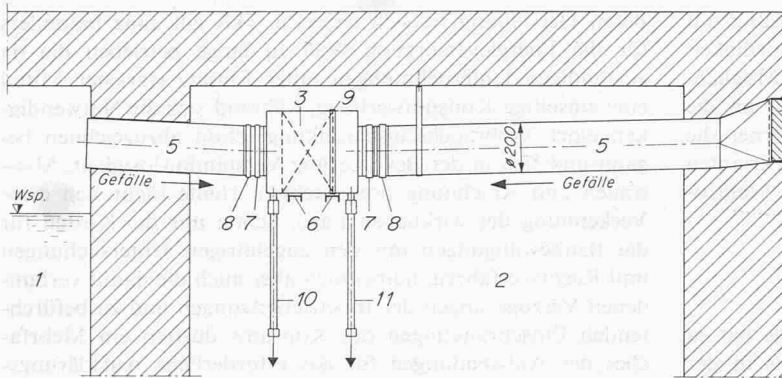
Luftfilterinstallation in einem Wasserreservoir nach dem geschlossenen System
